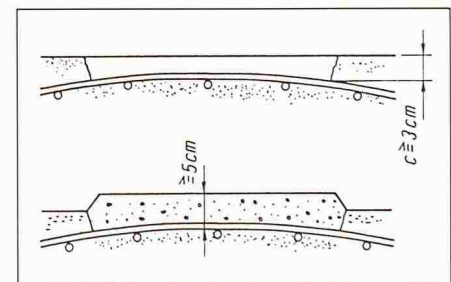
Sanieren einer Tunnelinnenschale aus Stahlbeton bei zu geringer Betonüberdeckung der Bewehrung mit Stahlfaserspritzbeton
